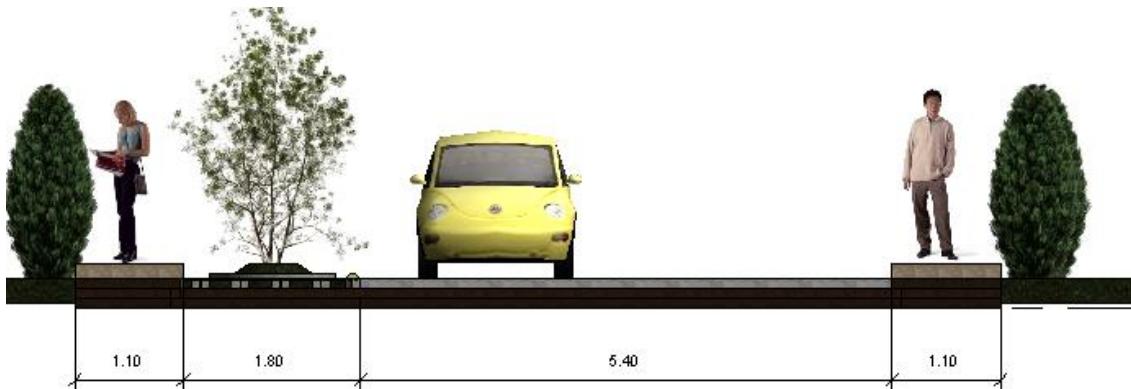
Vista Referencial de la berma verde en la sección vial de todo el proyecto
